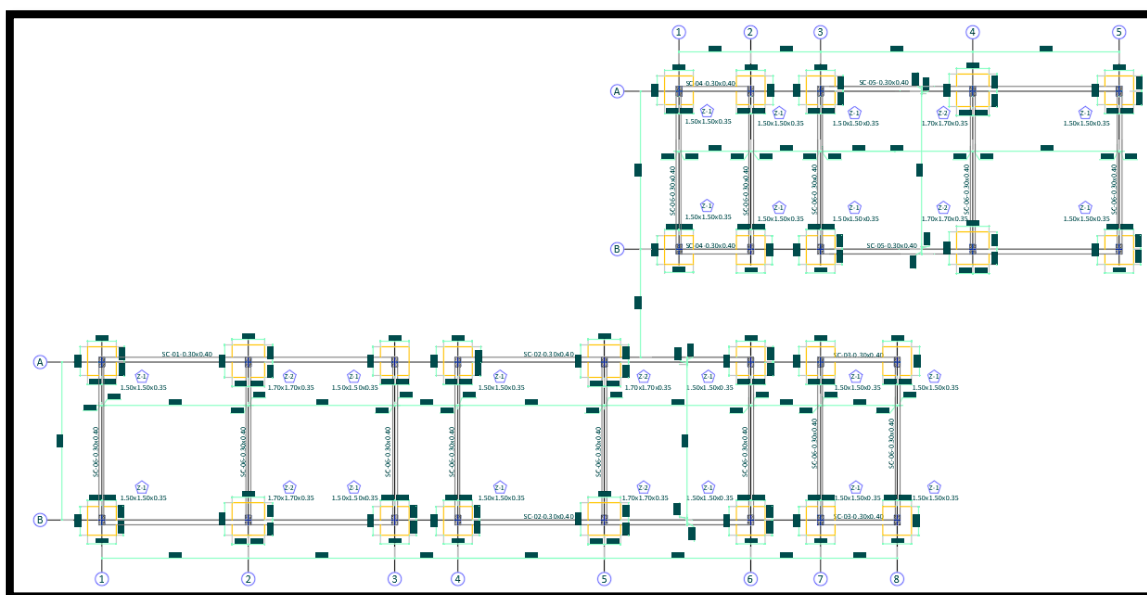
Planos de la distribución de las zapatas. Fuente: Diseño Estructural.
